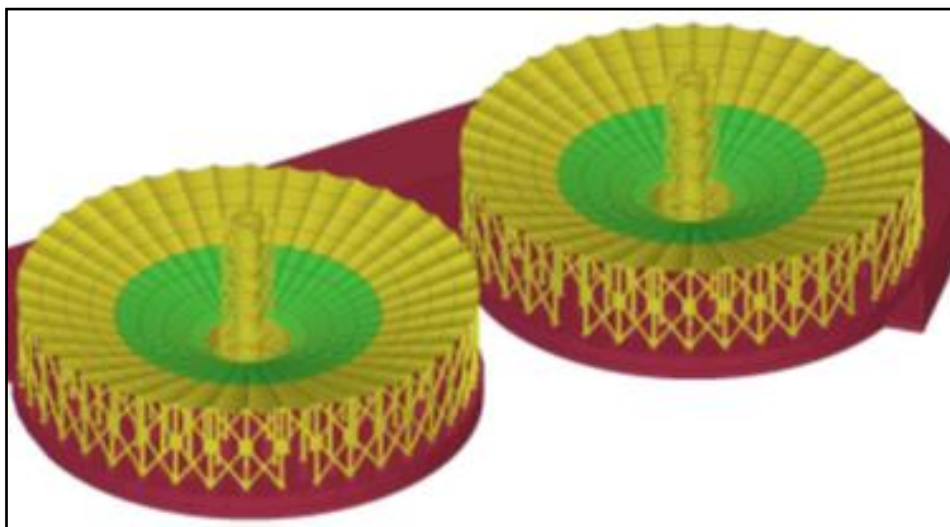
Vista CAD de Planchas de fondo tipo 2
